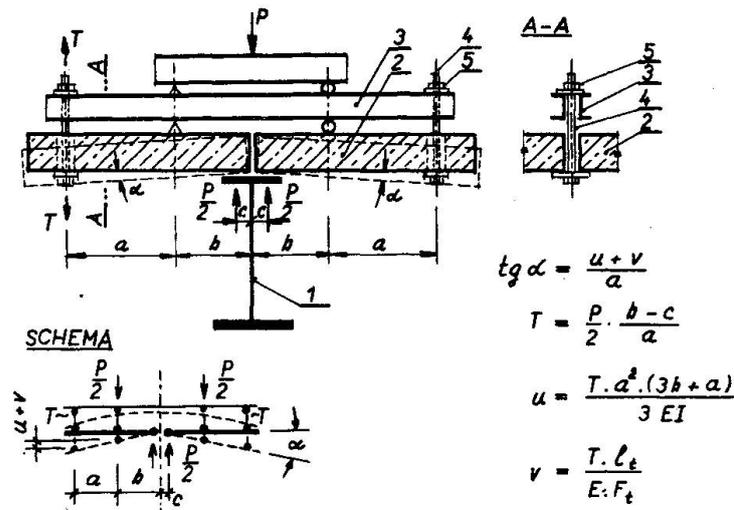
Prüfungen mit Trägerspannweite 12,00 m (1-Versuchsträger, 2-Stahlbetonfertigteile, 3-Hilfsquerbalken, 4-Zugstangen, 5-Rektifikationsschraube)
